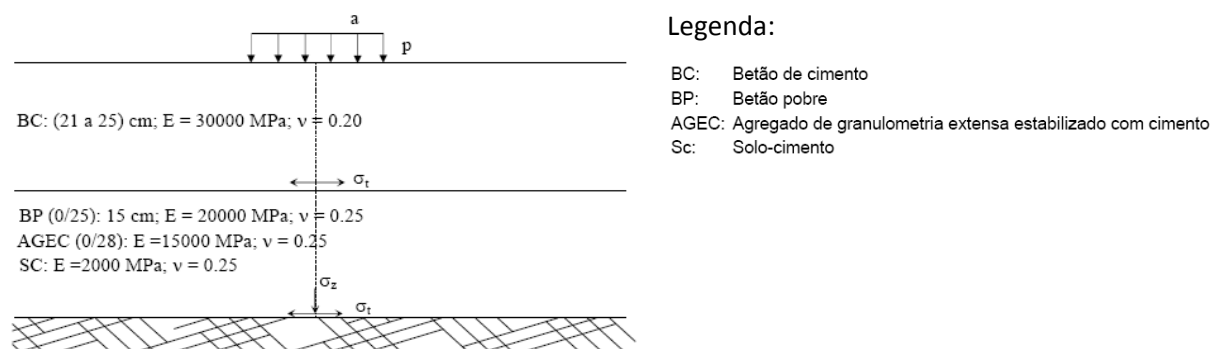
Estrutura possível para uma solução de pavimento rígido (Fonte: Paulo Fonseca)
